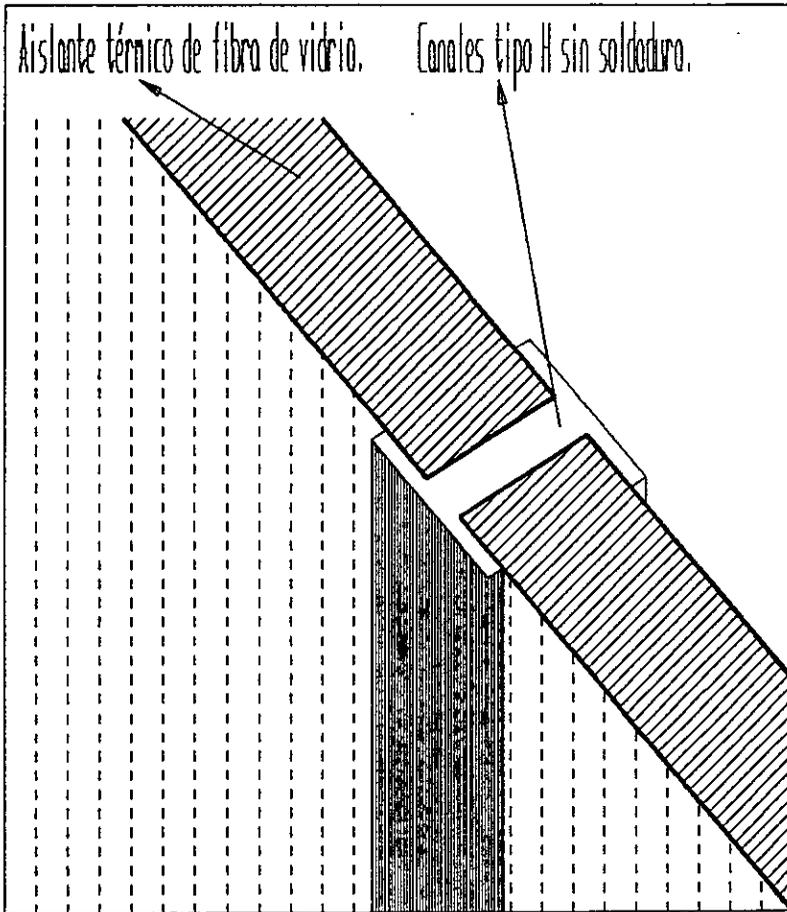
Paneles modulares aislados térmicamente y unidos por canales tipo H.
